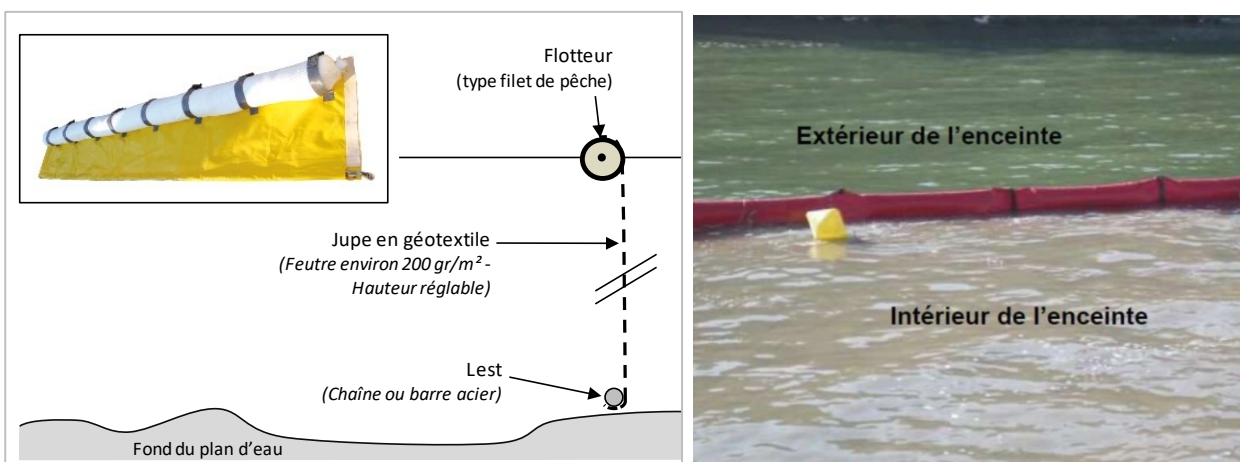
Schéma de principe et photo d'un barrage anti-MES
